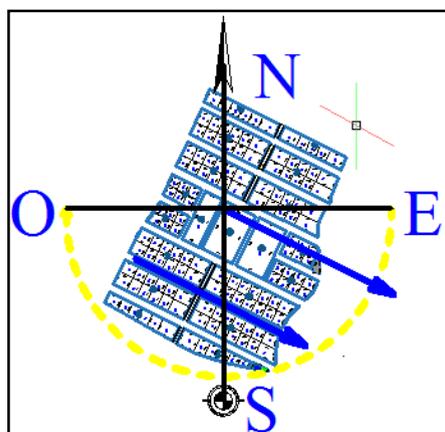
Asoleamiento zona 1 Condor Pasa.
